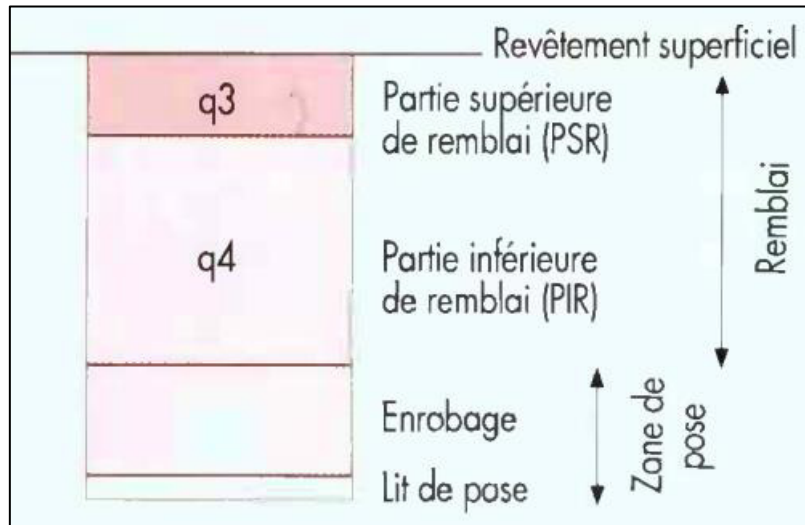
Cas d'une tranchée sous trottoir, Guide de remblayage des tranchées et réfection des chaussées
